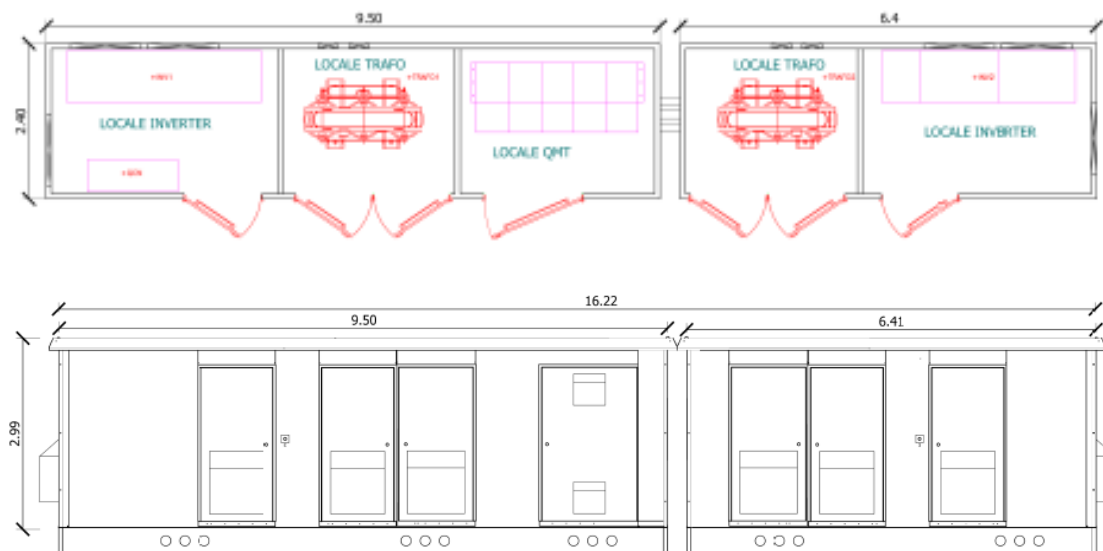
Pianta e prospetto cabina di conversione e trasformazione con due inverter
